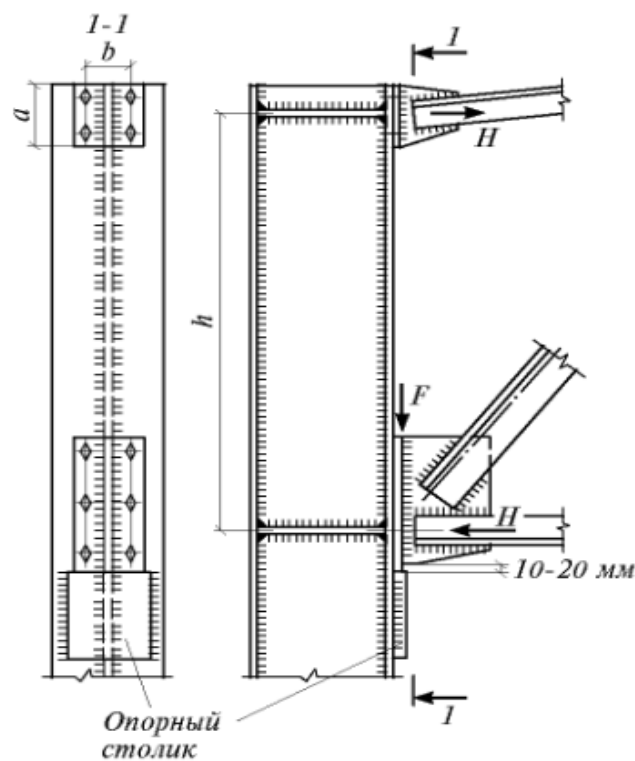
Общий вид жесткого узла сопряжения колонны со стропильной фермой
